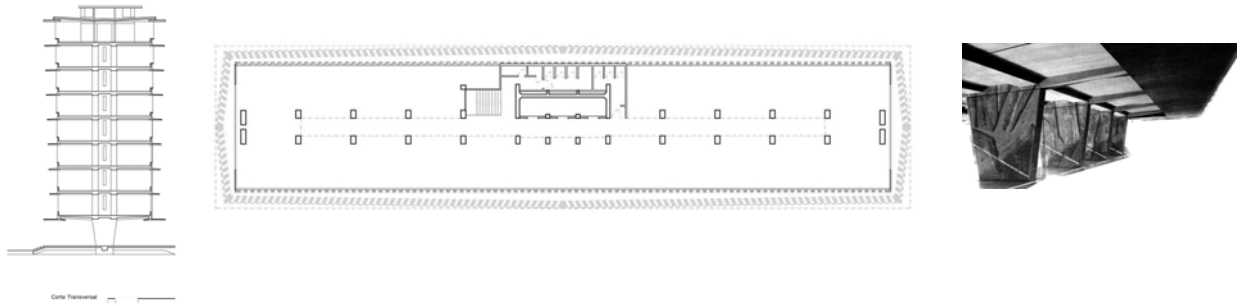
Corte transversal, planta tipo y foto detalle borde de losa
